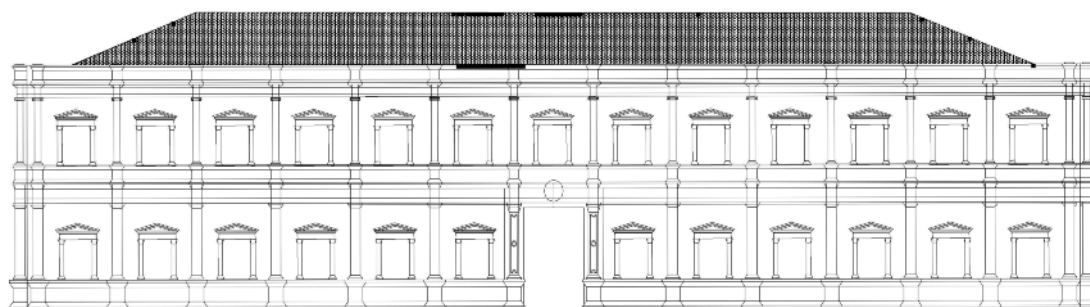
Reconstrucción del alzado de la Casa de Hernando Colón.
